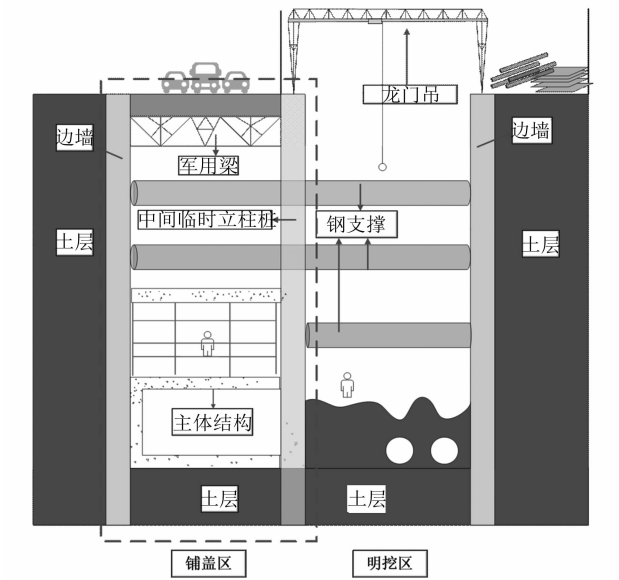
半幅铺盖法施工的地铁车站基坑剖面示意图
